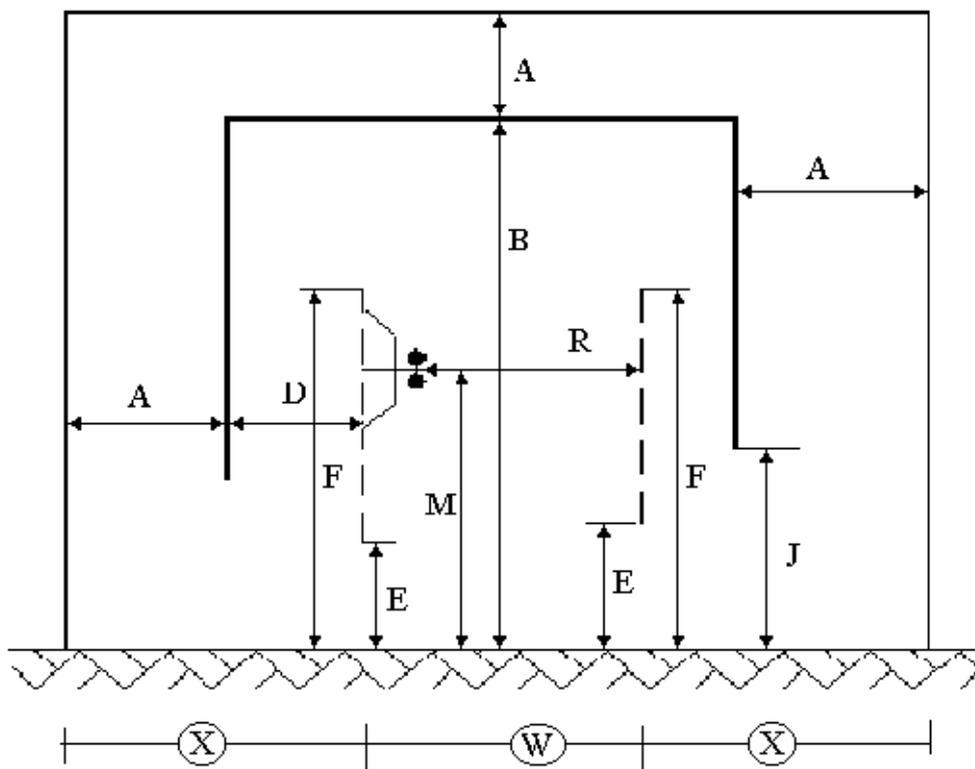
(b) – Espaçamento para instalações internas – circulação por mais de um lado
